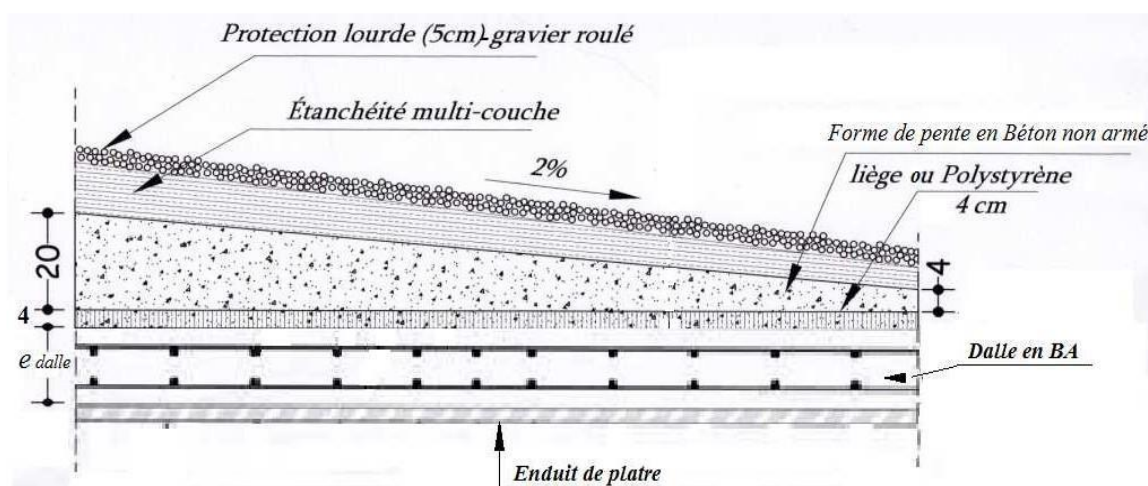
Détails d'un plancher en dalle pleine en béton armé (Plancher terrasse inaccessible)
